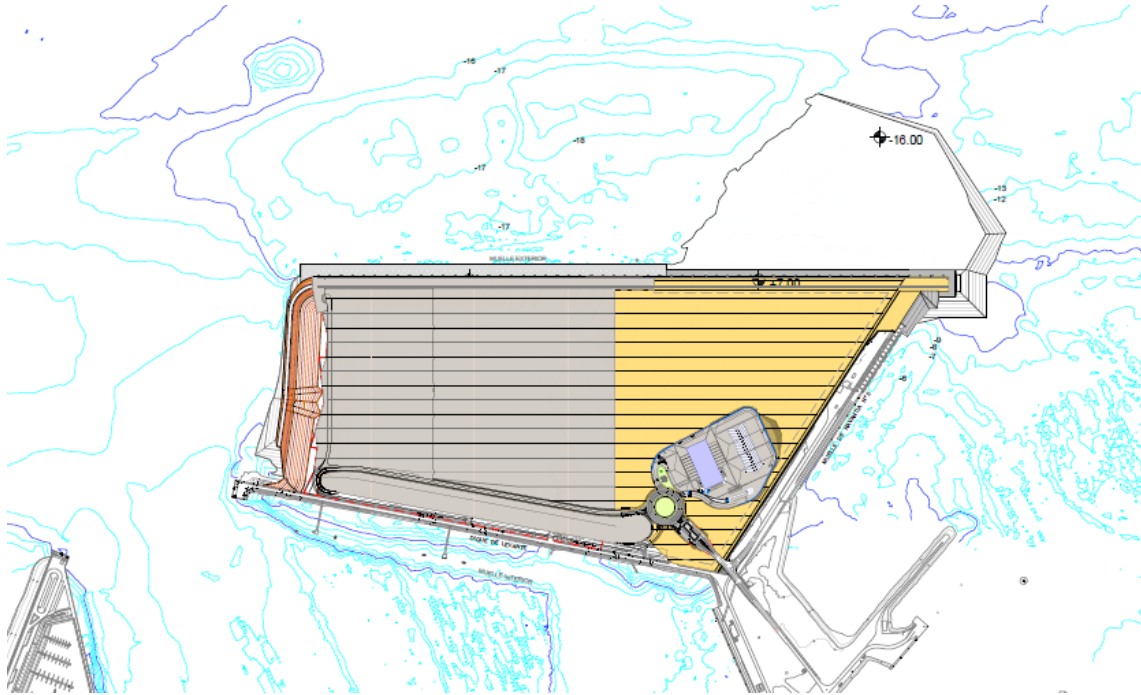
Planta de las fases I y II de la NTC. Fuente: APBC
